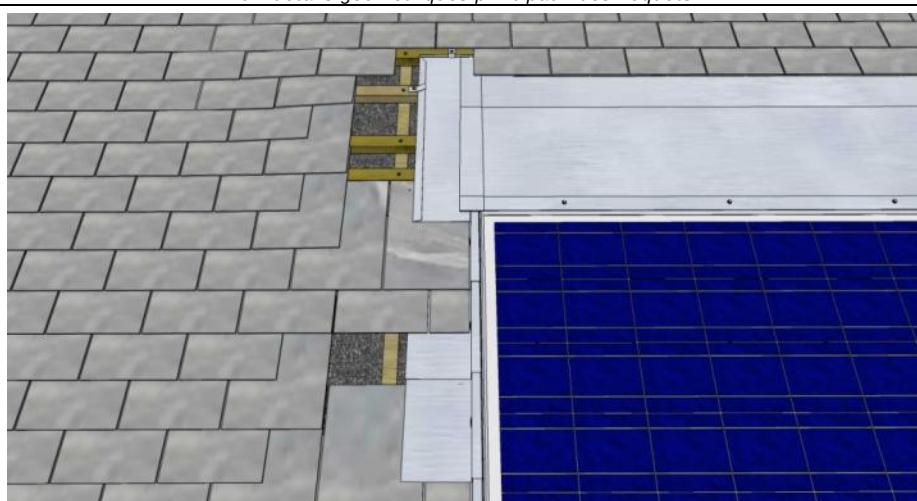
Coupe longitudinale de l'abergement gauche
